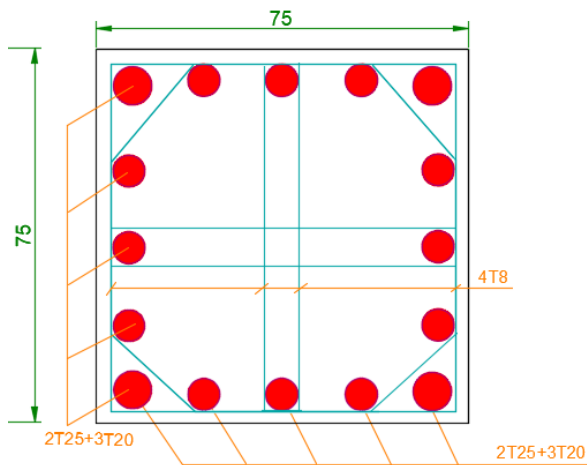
Schéma De Ferrailage Des Poteaux S-S et RDC.
